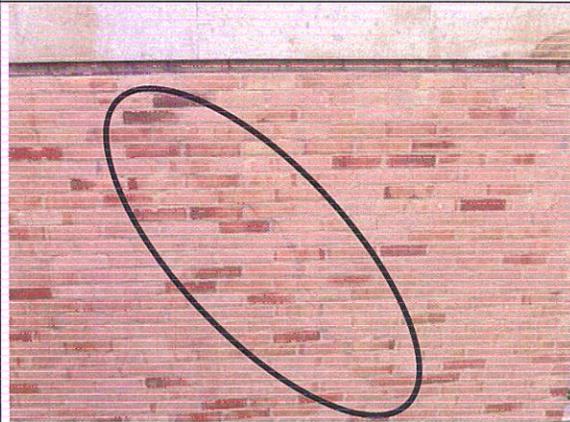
Fisuras en muros de fachada de la etapa V.
